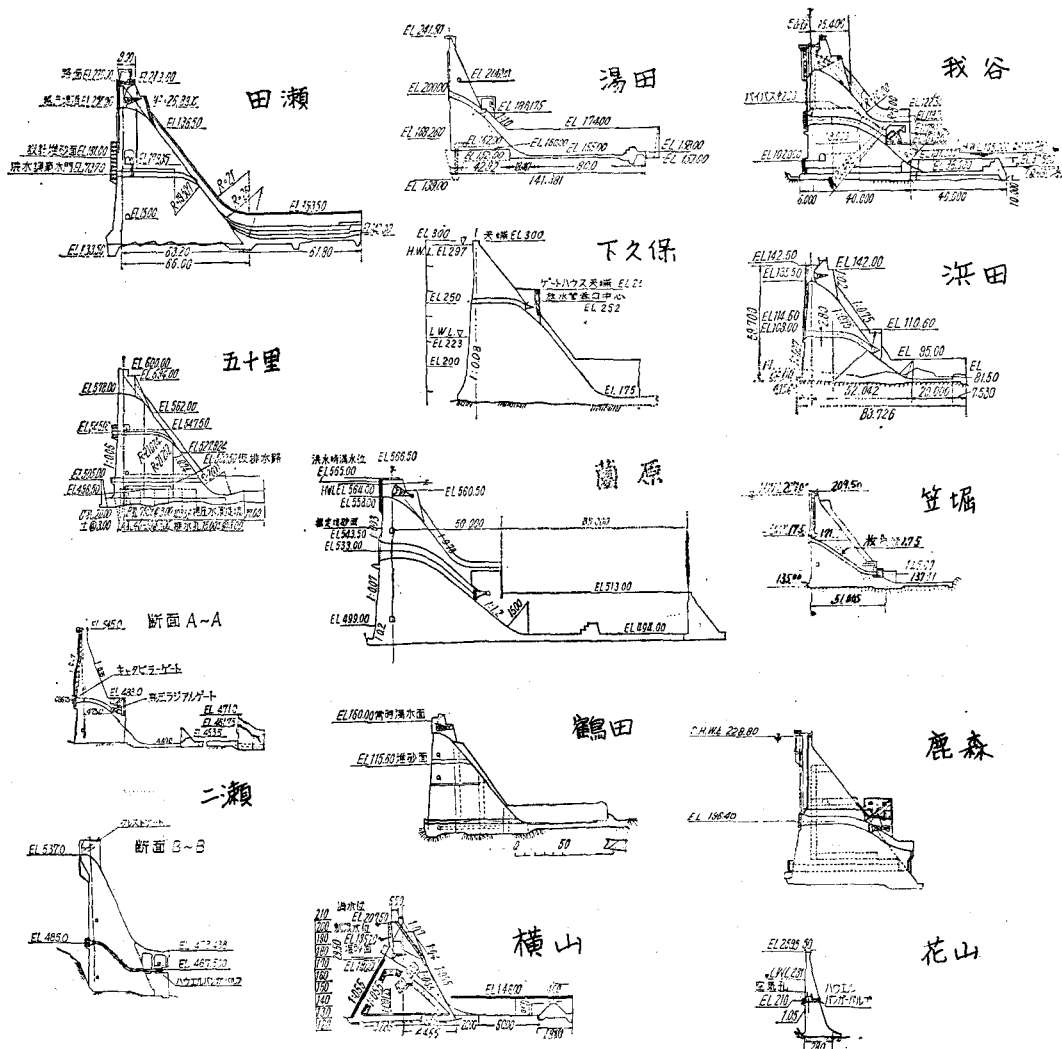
多目的ダム（建設省直轄および補助）の outlet works³⁾
